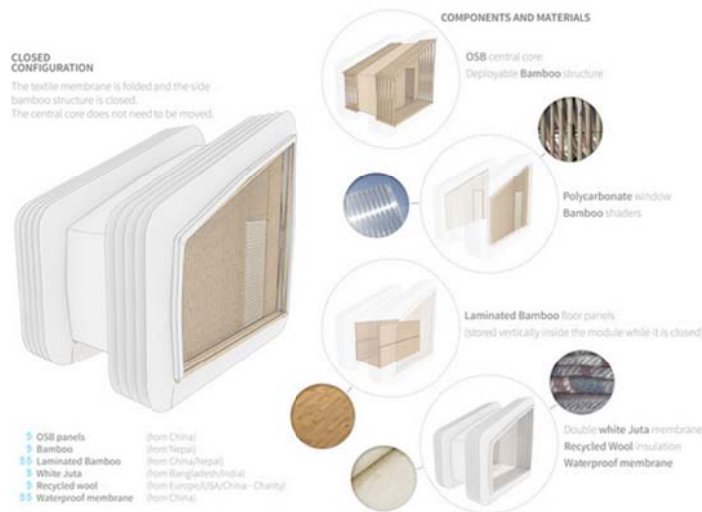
João Boto Caeiro & Maria da Paz Braga, 2015. (Fuente: www.mejorarq.com)
